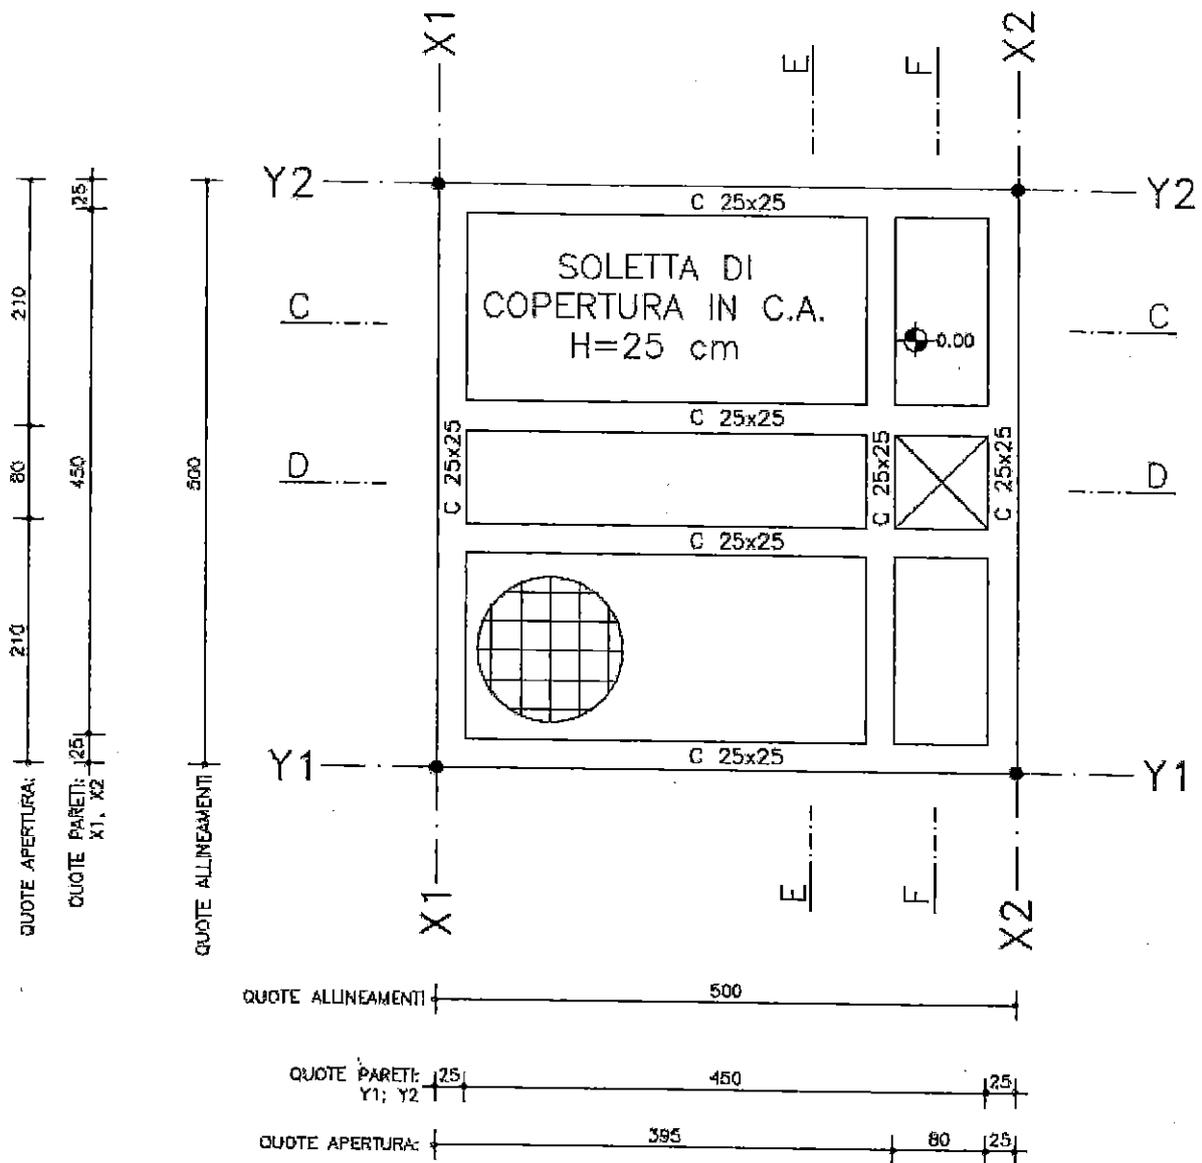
Pianta cisterna di raccolta di acque meteoriche
